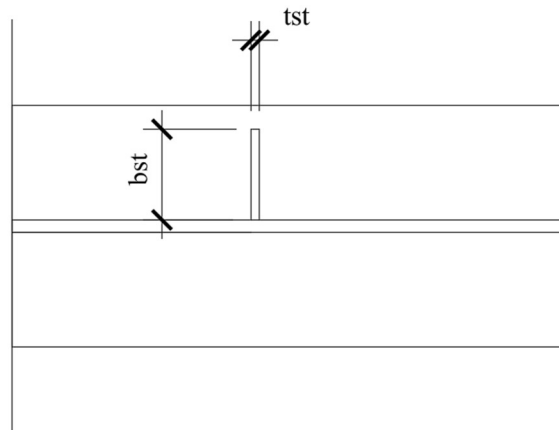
Planta baixa dos enrijecedores transversais.
